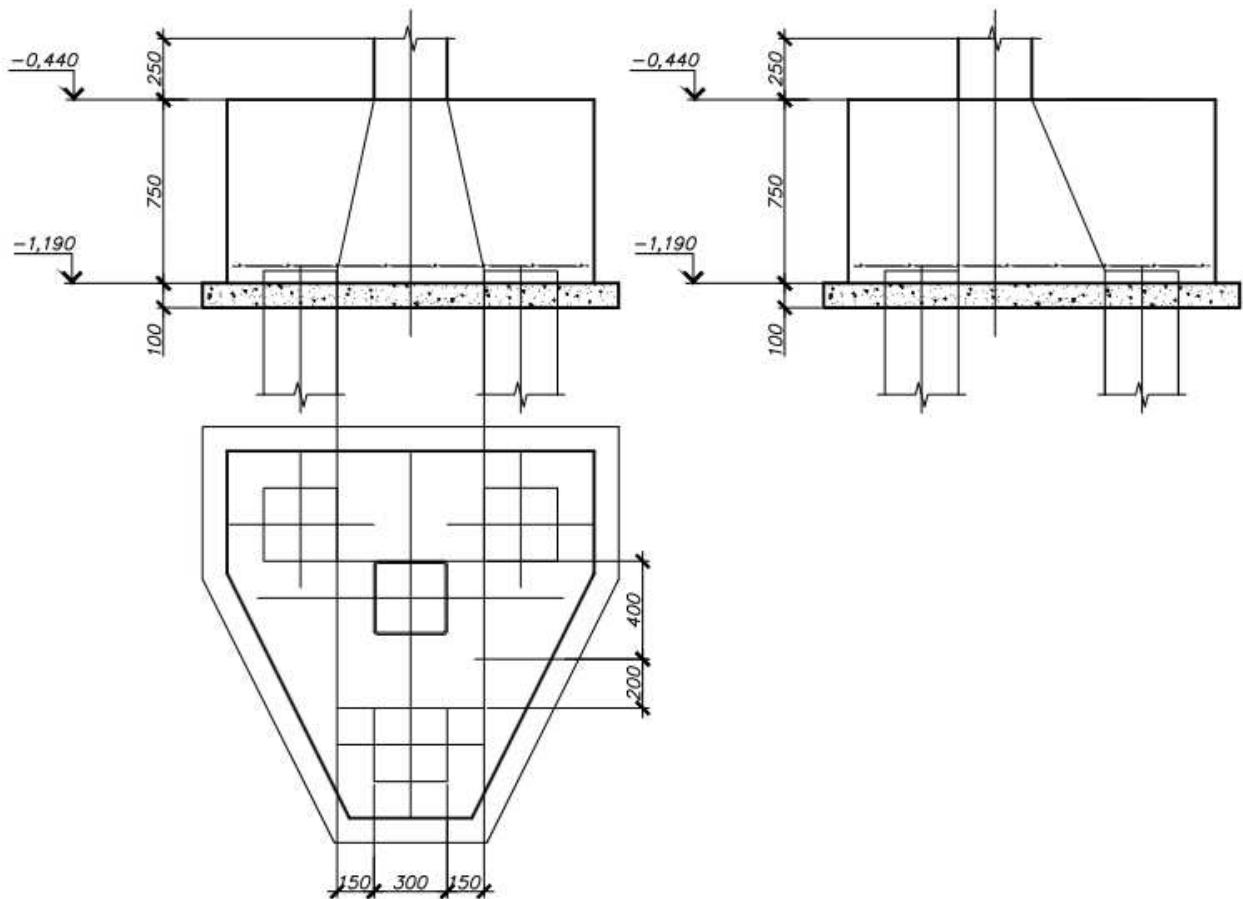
Схема работы ростверка на продавливание колонной
